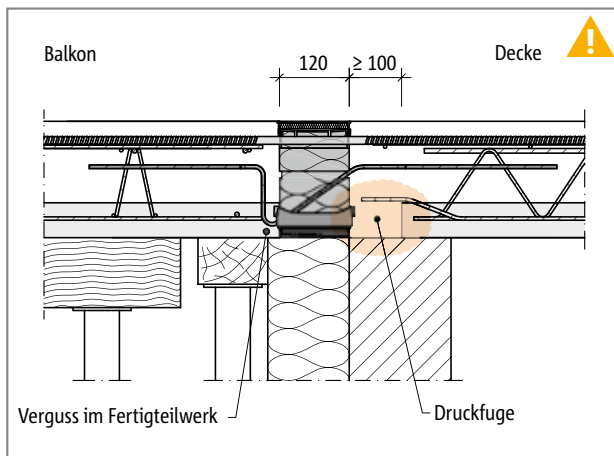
Schöck Isokorb® CXT Typ K-F: Druckfuge deckenseitig in Verbindung mit Elementplatten; direkte Lagerung
